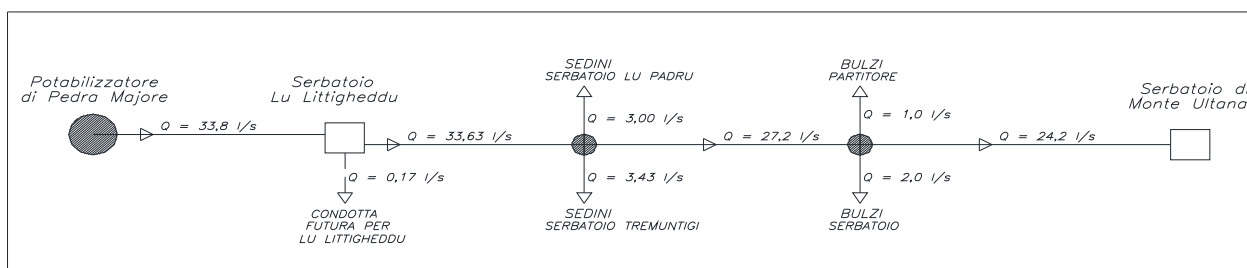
Schema di erogazione per il tratto di adduttrice in progetto
